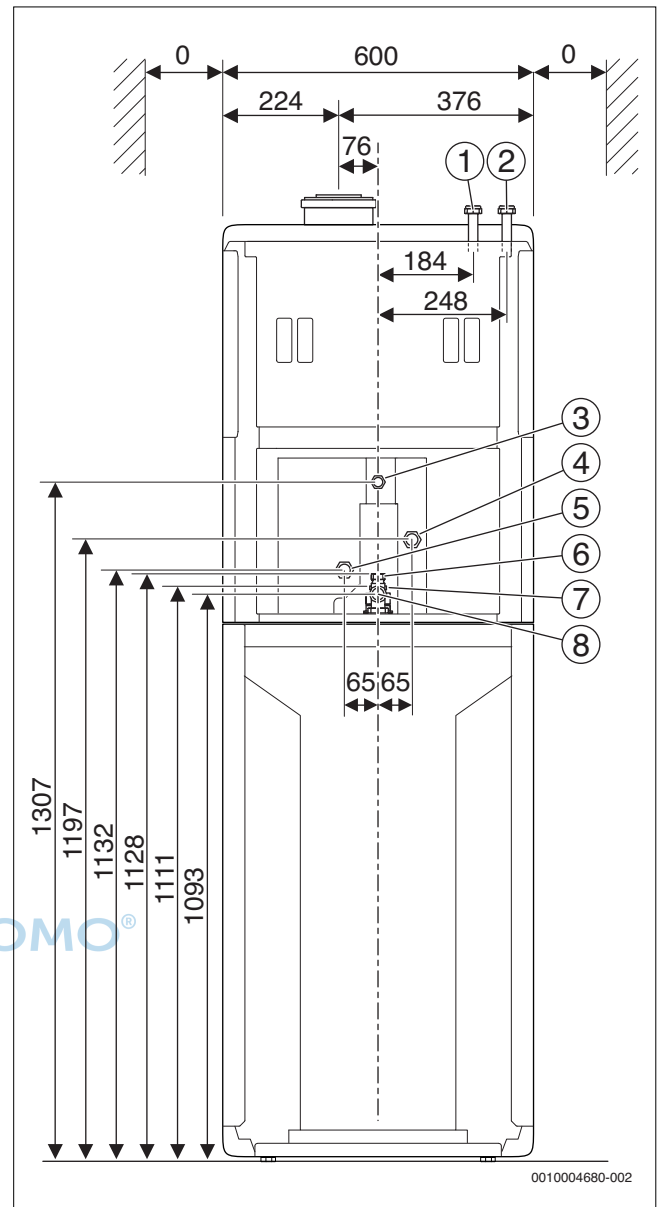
Abmessungen und Anschlüsse ohne Zubehör
